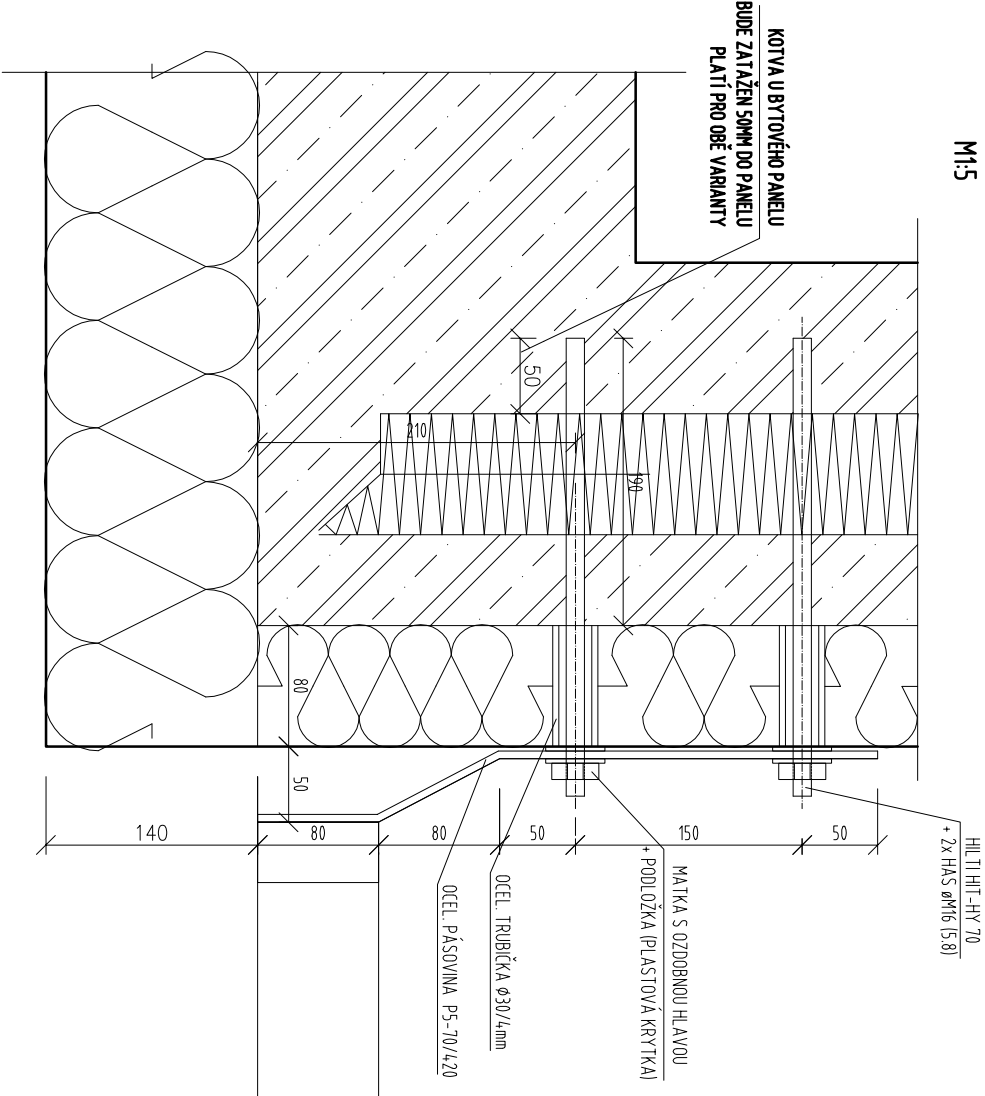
DETAIL KOTVENÍ ZÁBRADLÍ PŘED PROVEDENÍM ZATEPLENÍ - VARIANTA 2
